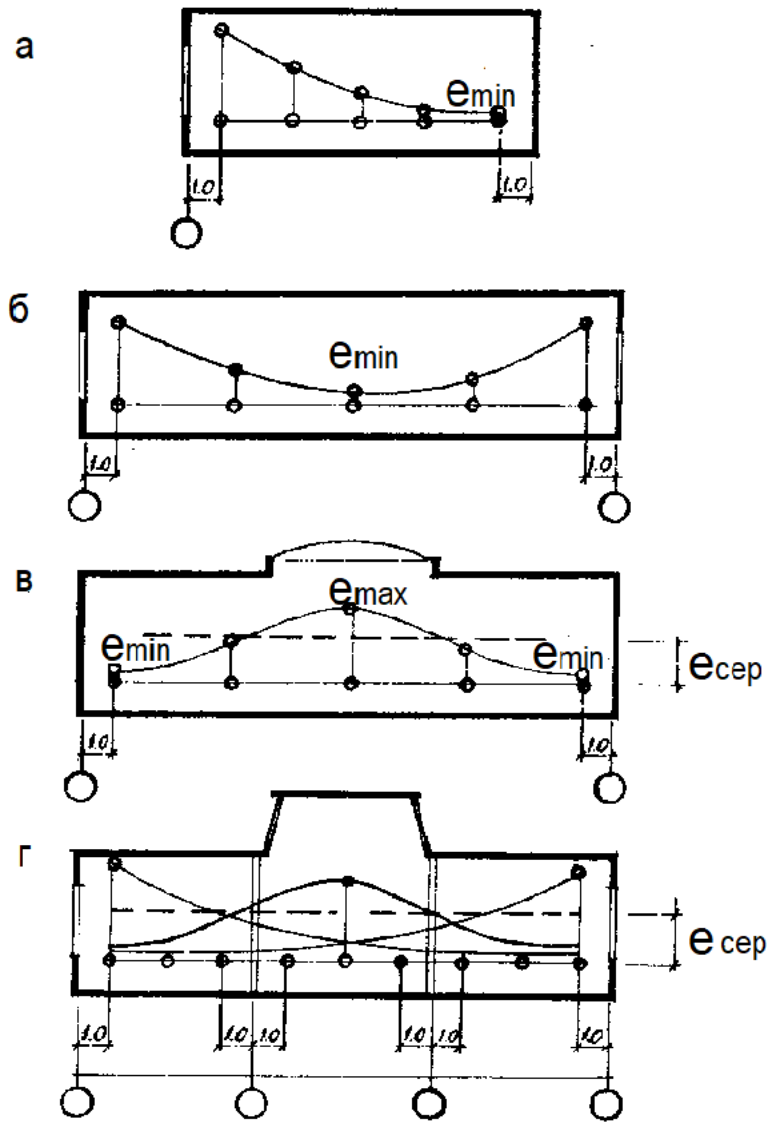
Розрахункові точки на робочій поверхні [5]
